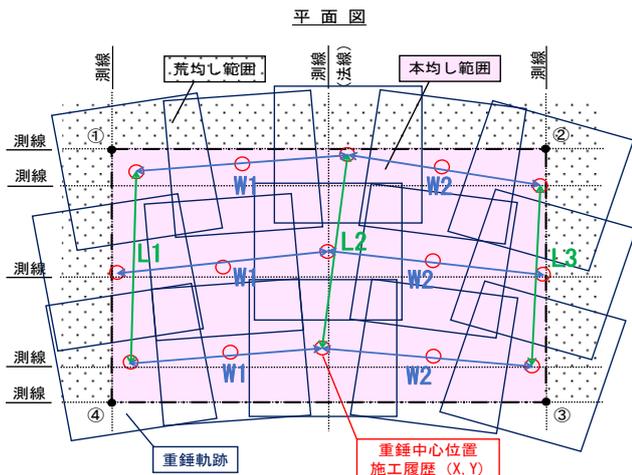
施工中の施工履歴データによる捨石本均しの距離計測
